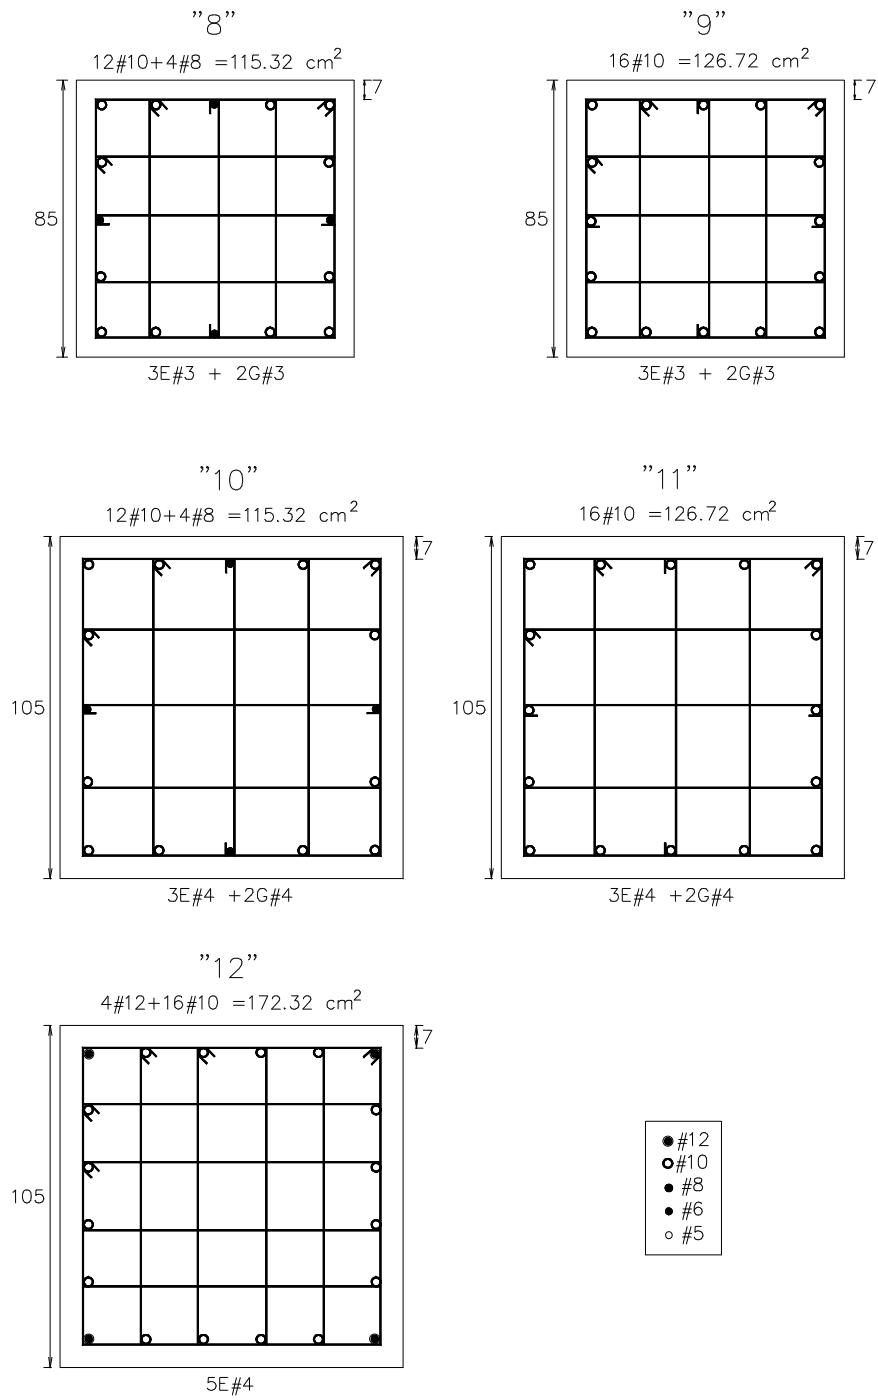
Tipos de armados propuestos para las columnas del eje 2, estructuras de 17 niveles diseñadas en zona II (RDF-93 y RDF-04)
